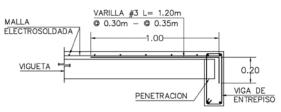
Detalle de refuerzo sísmico paralelo a las viguetas
